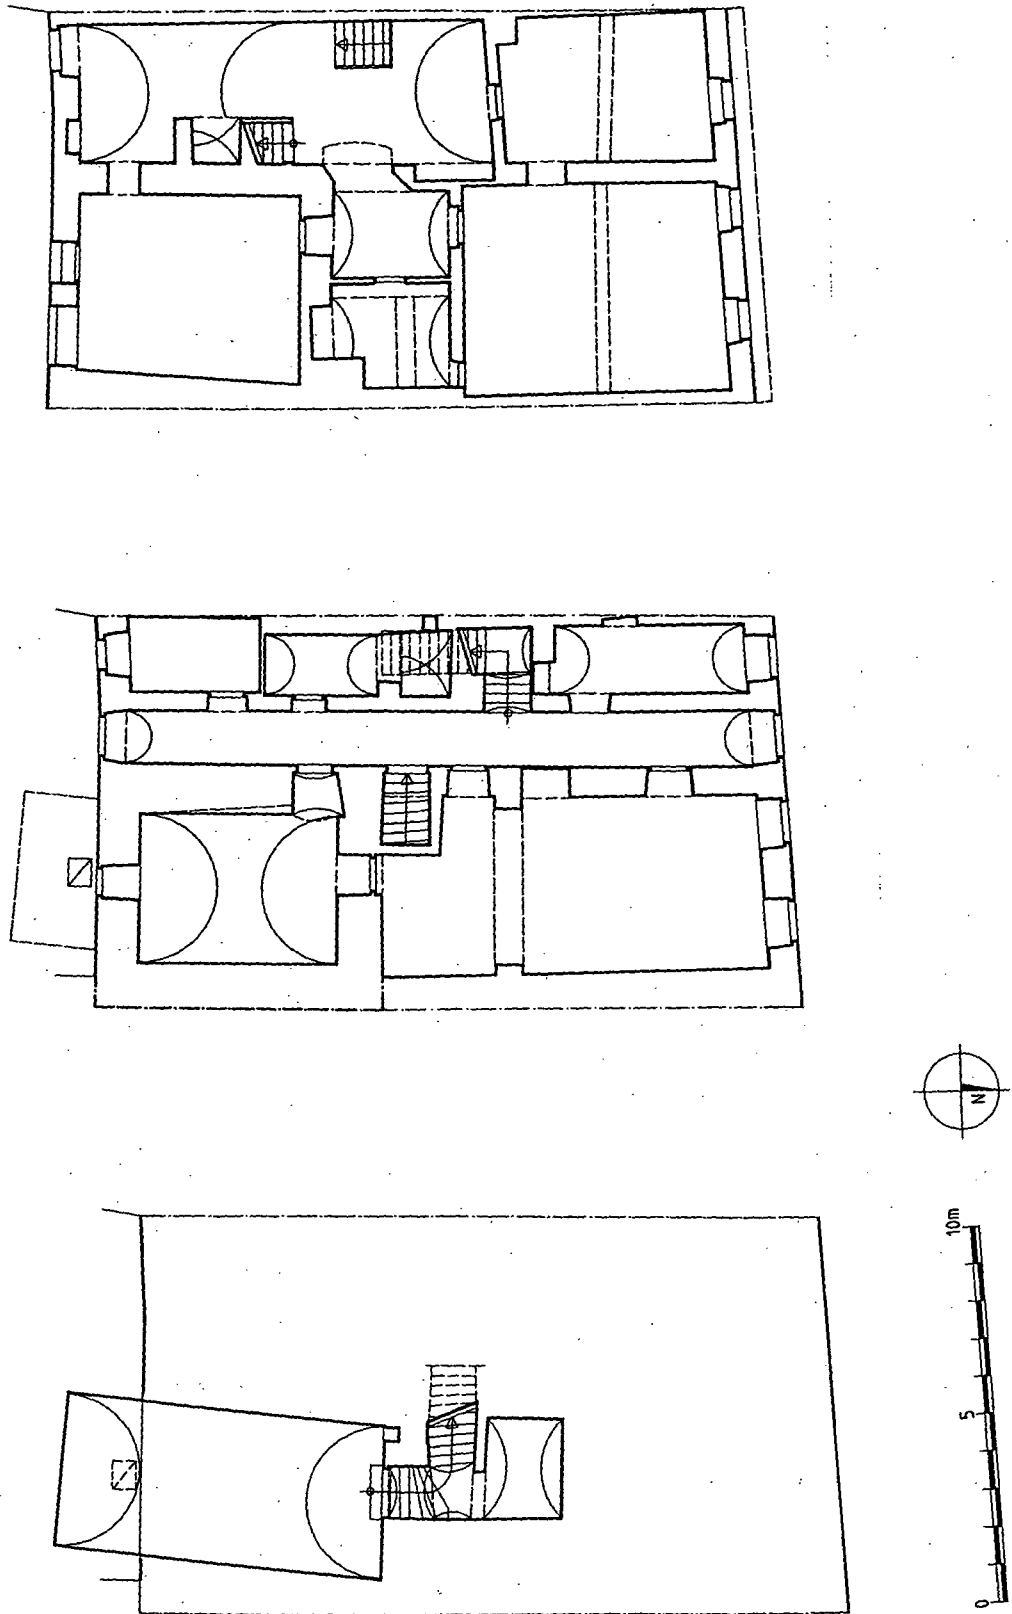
Schmiedstraße 7 – Grundrisse Keller, Erdgeschoss, Obergeschoss (1:200).
